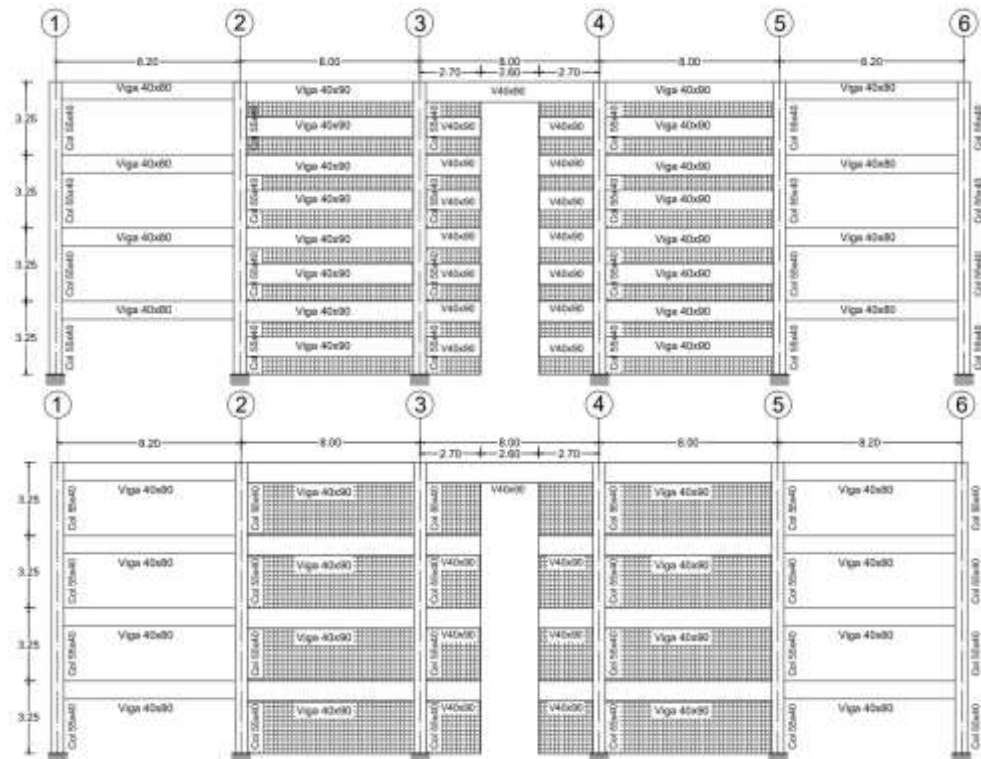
Pórtico del eje D del Parqueadero de ULEAM; en la gráfica superior se ven las vigas de entrepiso y los muros que se construyeron para evitar el problema de columna corta; en la gráfica inferior se presenta los muros en cada piso, para el análisis sísmico.
